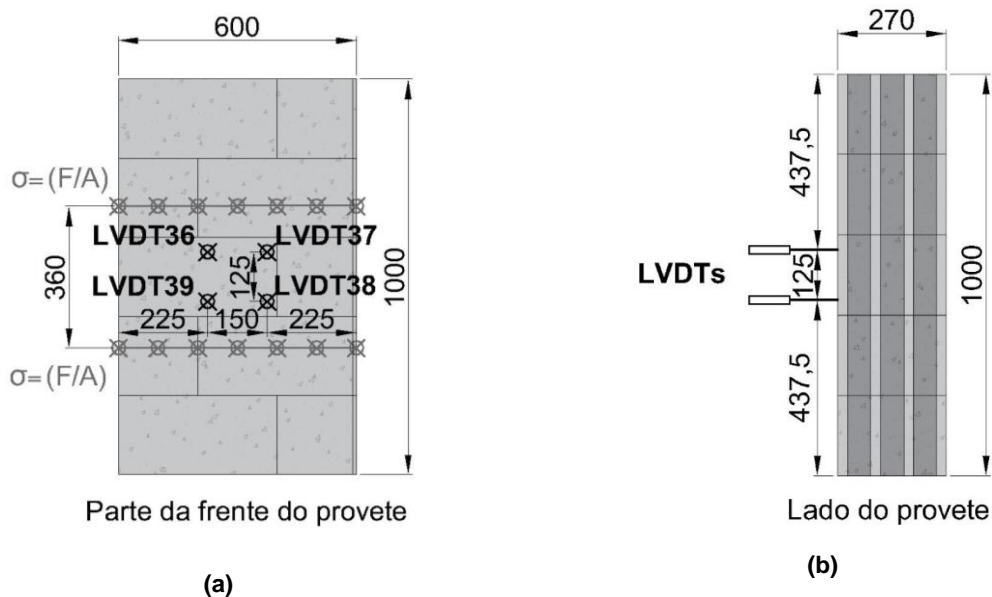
Esquema funcional do ensaio de caracterização mecânica à flexão segundo um plano de rotura paralelo às juntas horizontais e instrumentação adotada (dimensões em mm).
